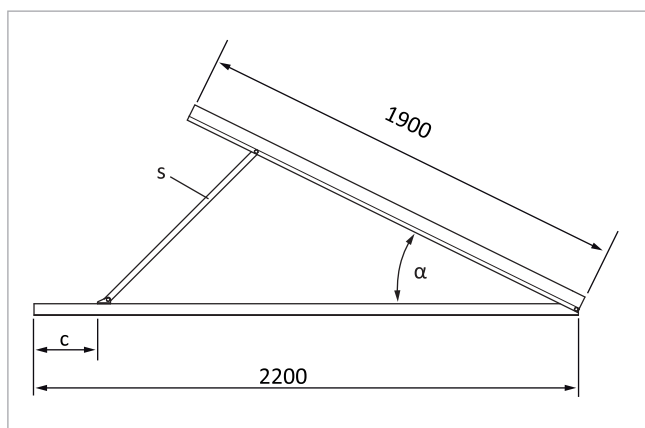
montants pour toit plat, dimensions et angle d'installation
